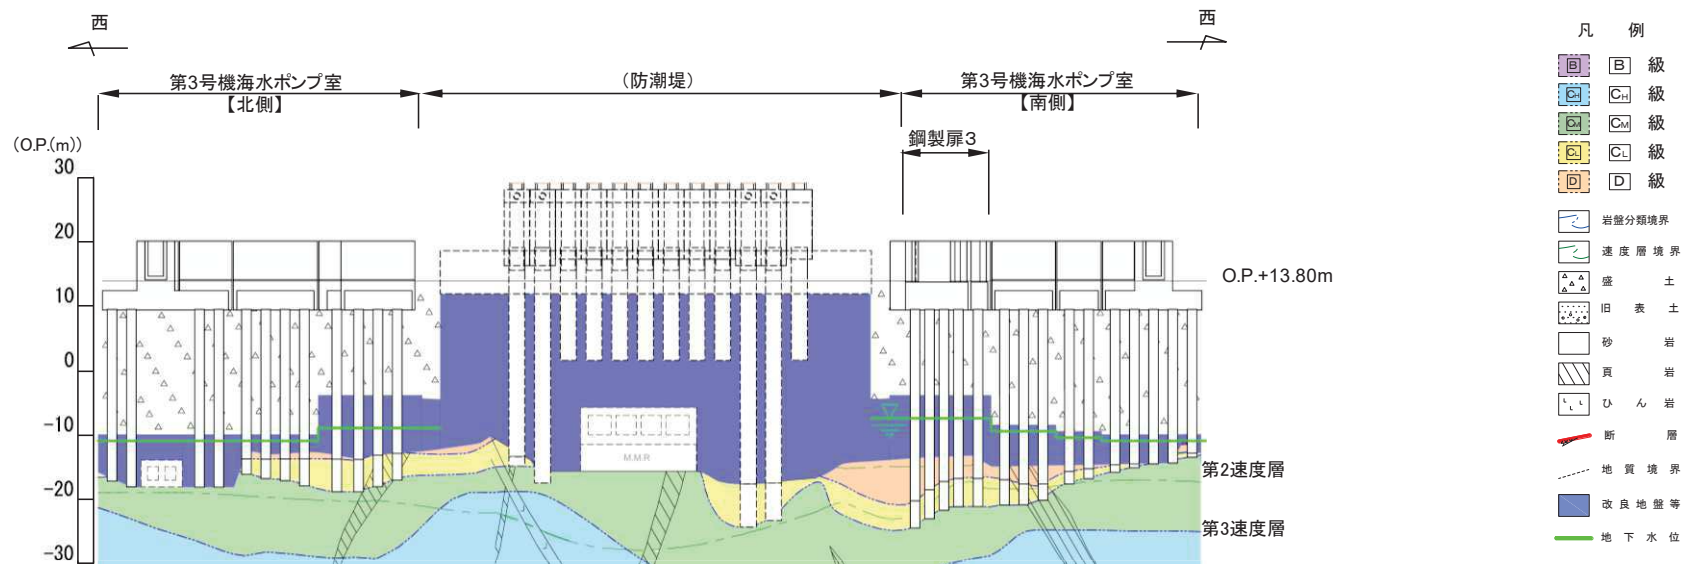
(3) 鋼製扉周辺の地質状況 (第3号機海水ポンプ室)
